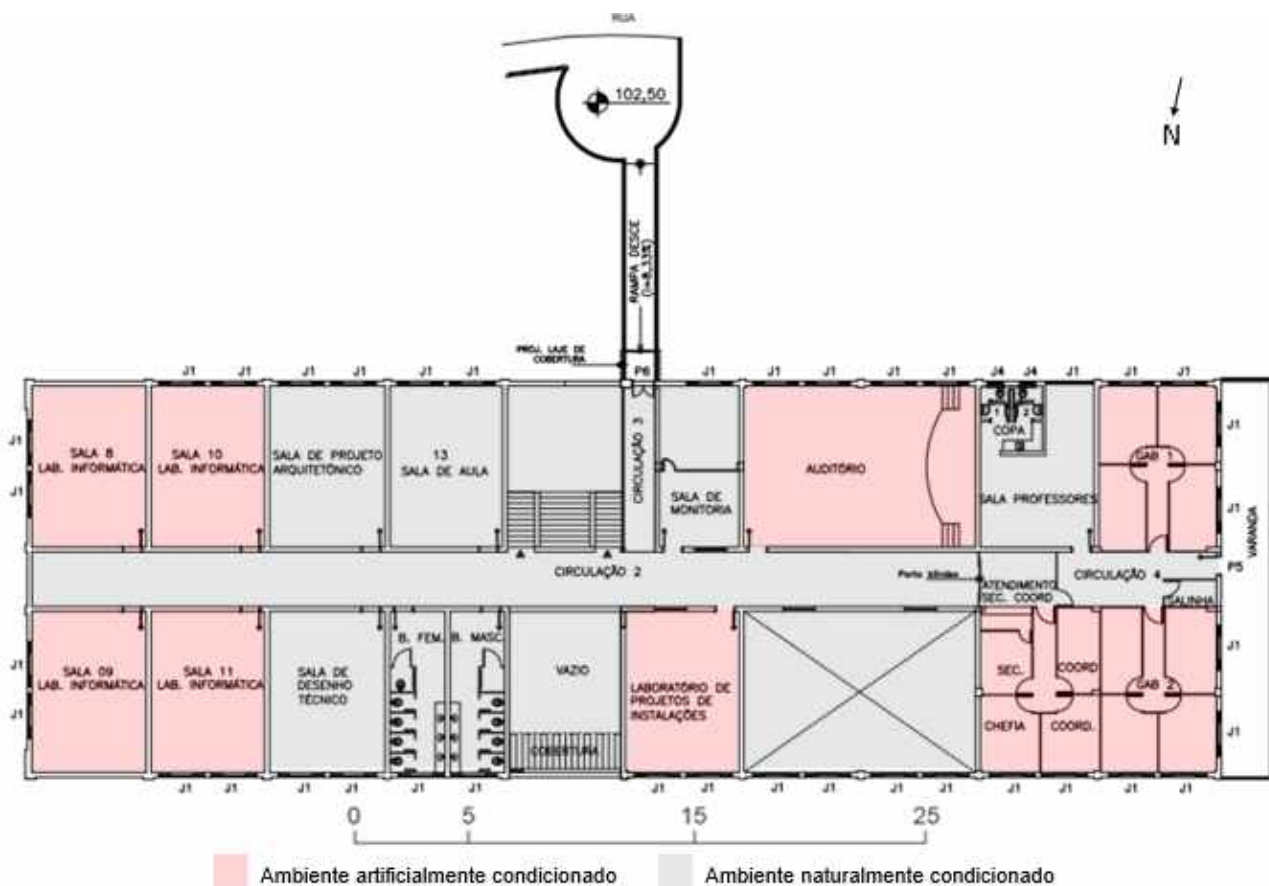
Planta baixa do Prédio 12 – 2º Pavimento
